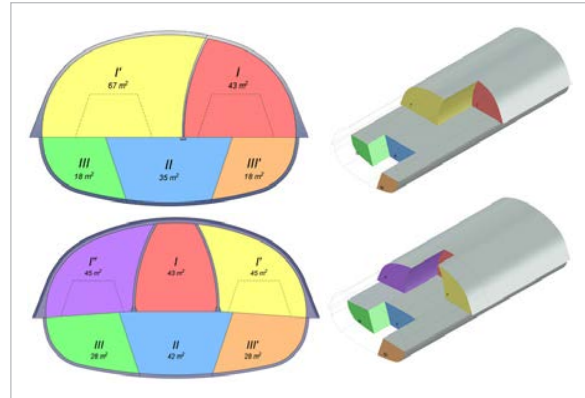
y 5b. Fases de excavación utilizadas para las secciones de 4 y 5 carriles. Túnel Kennedy.
